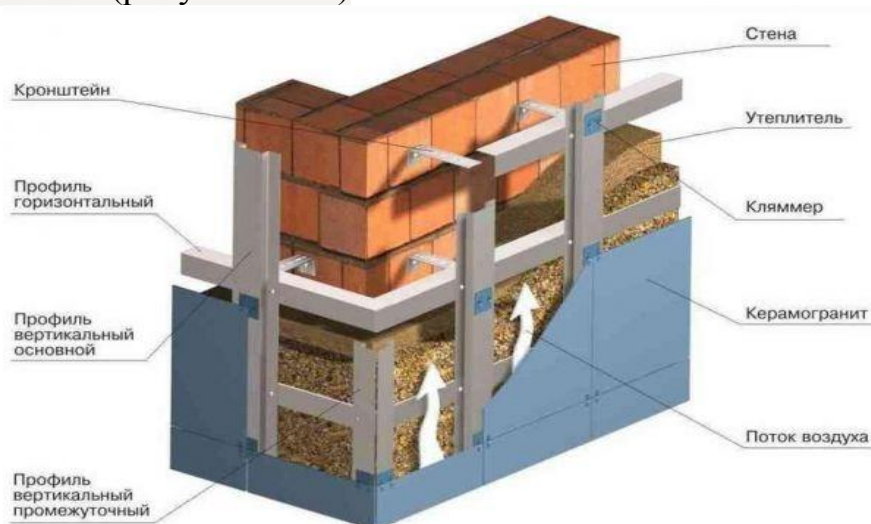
Конструкция навесного фасада из оцинкованной стали
